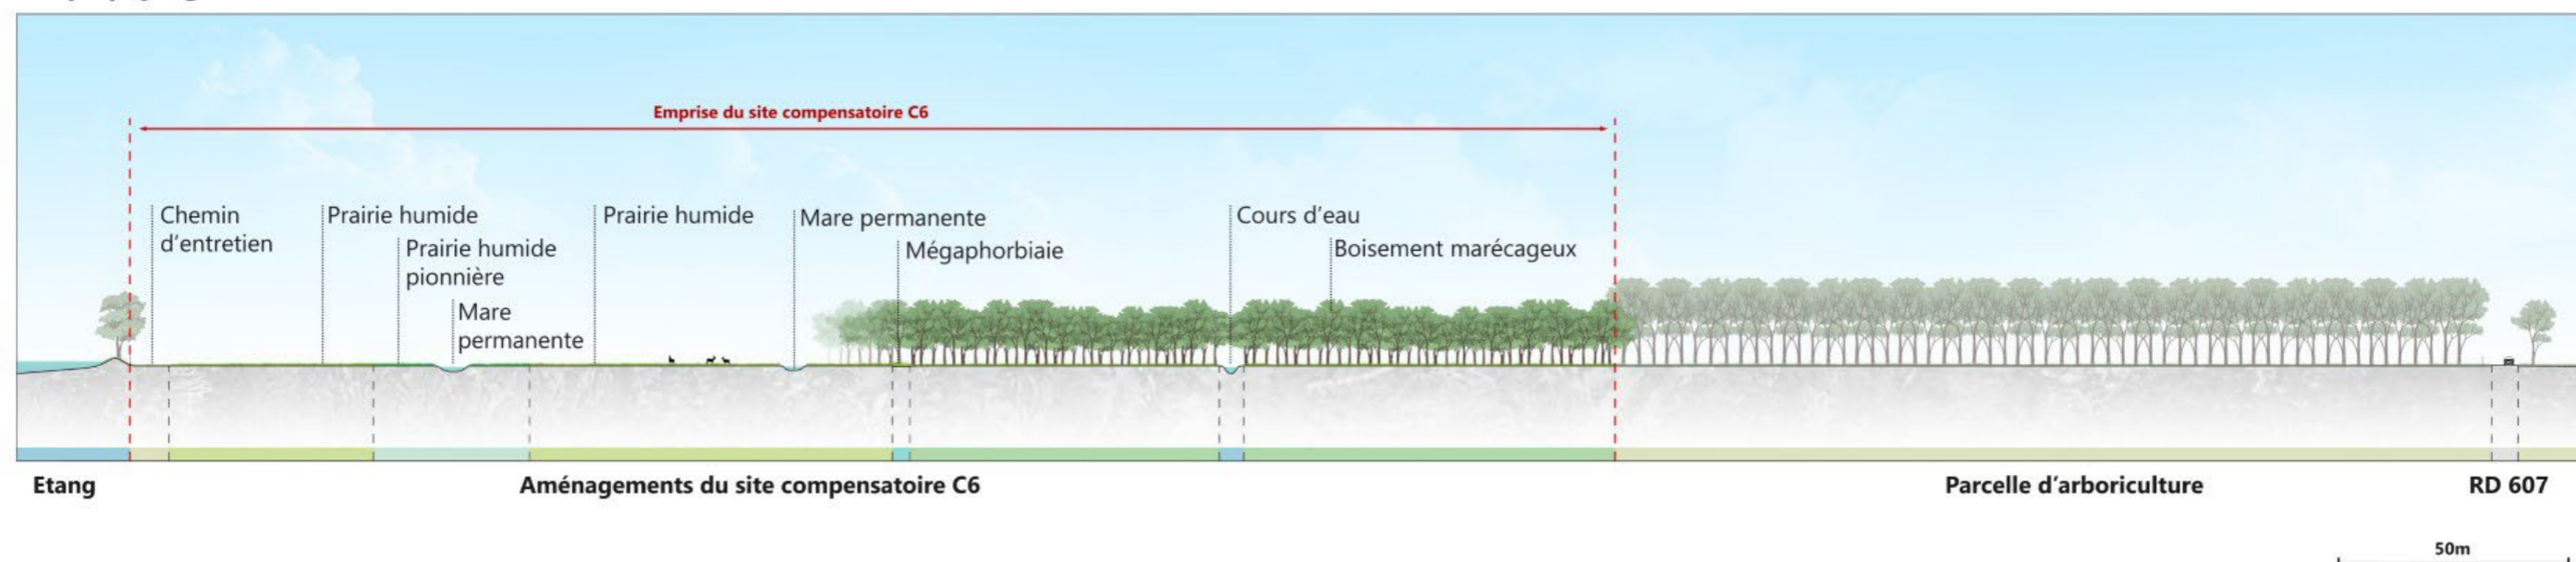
COUPE TRANSVERSALE PAYSAGERE - SOURCE : EGIS
